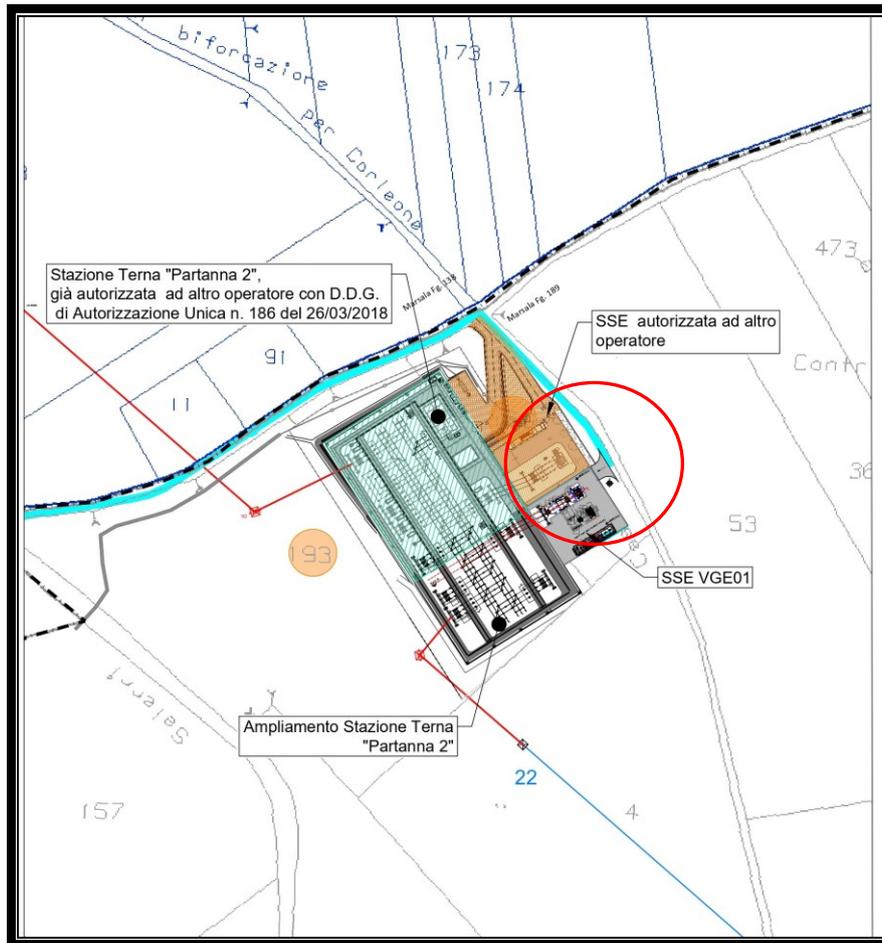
Planimetria con ubicazione della SSEU su catastale
